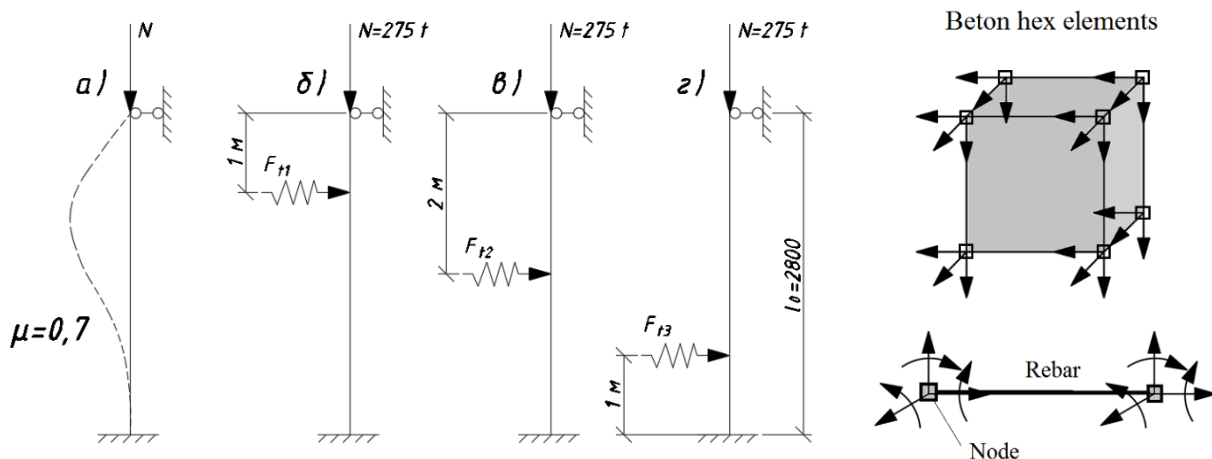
Схема нагружения колонны статической и динамической нагрузкой
